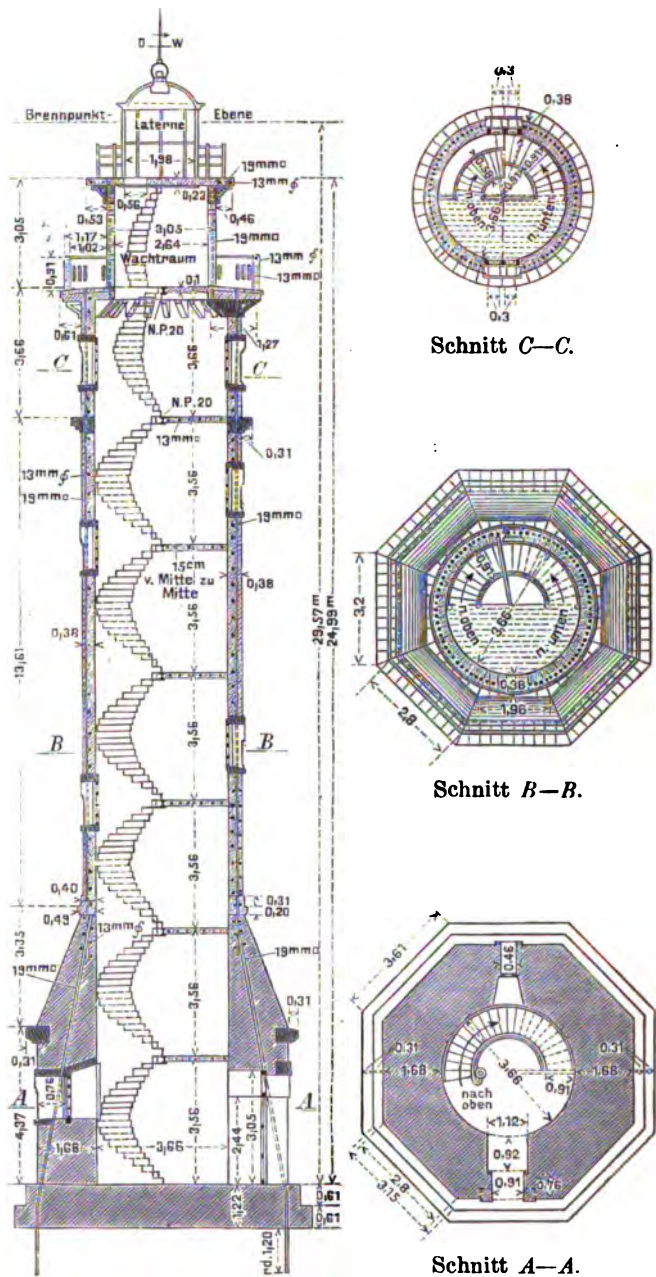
Durchschnitt und Grundriß des Leuchtturmes auf der Insel Maniguin.
